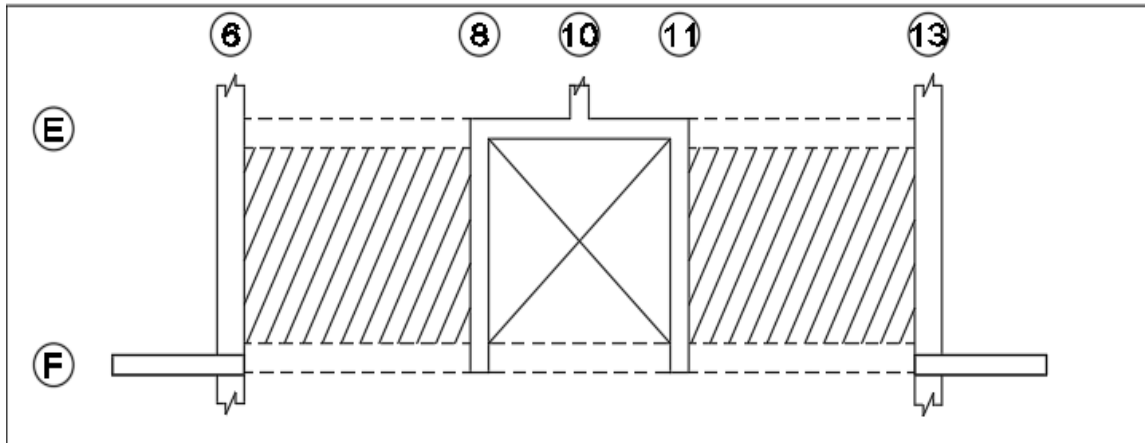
Ejemplo de losas macizas en planta de Estructuras
